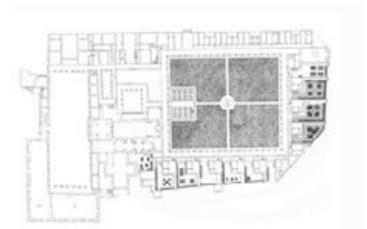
(2). Planta de conjunto. Monasterio d'Ena.
